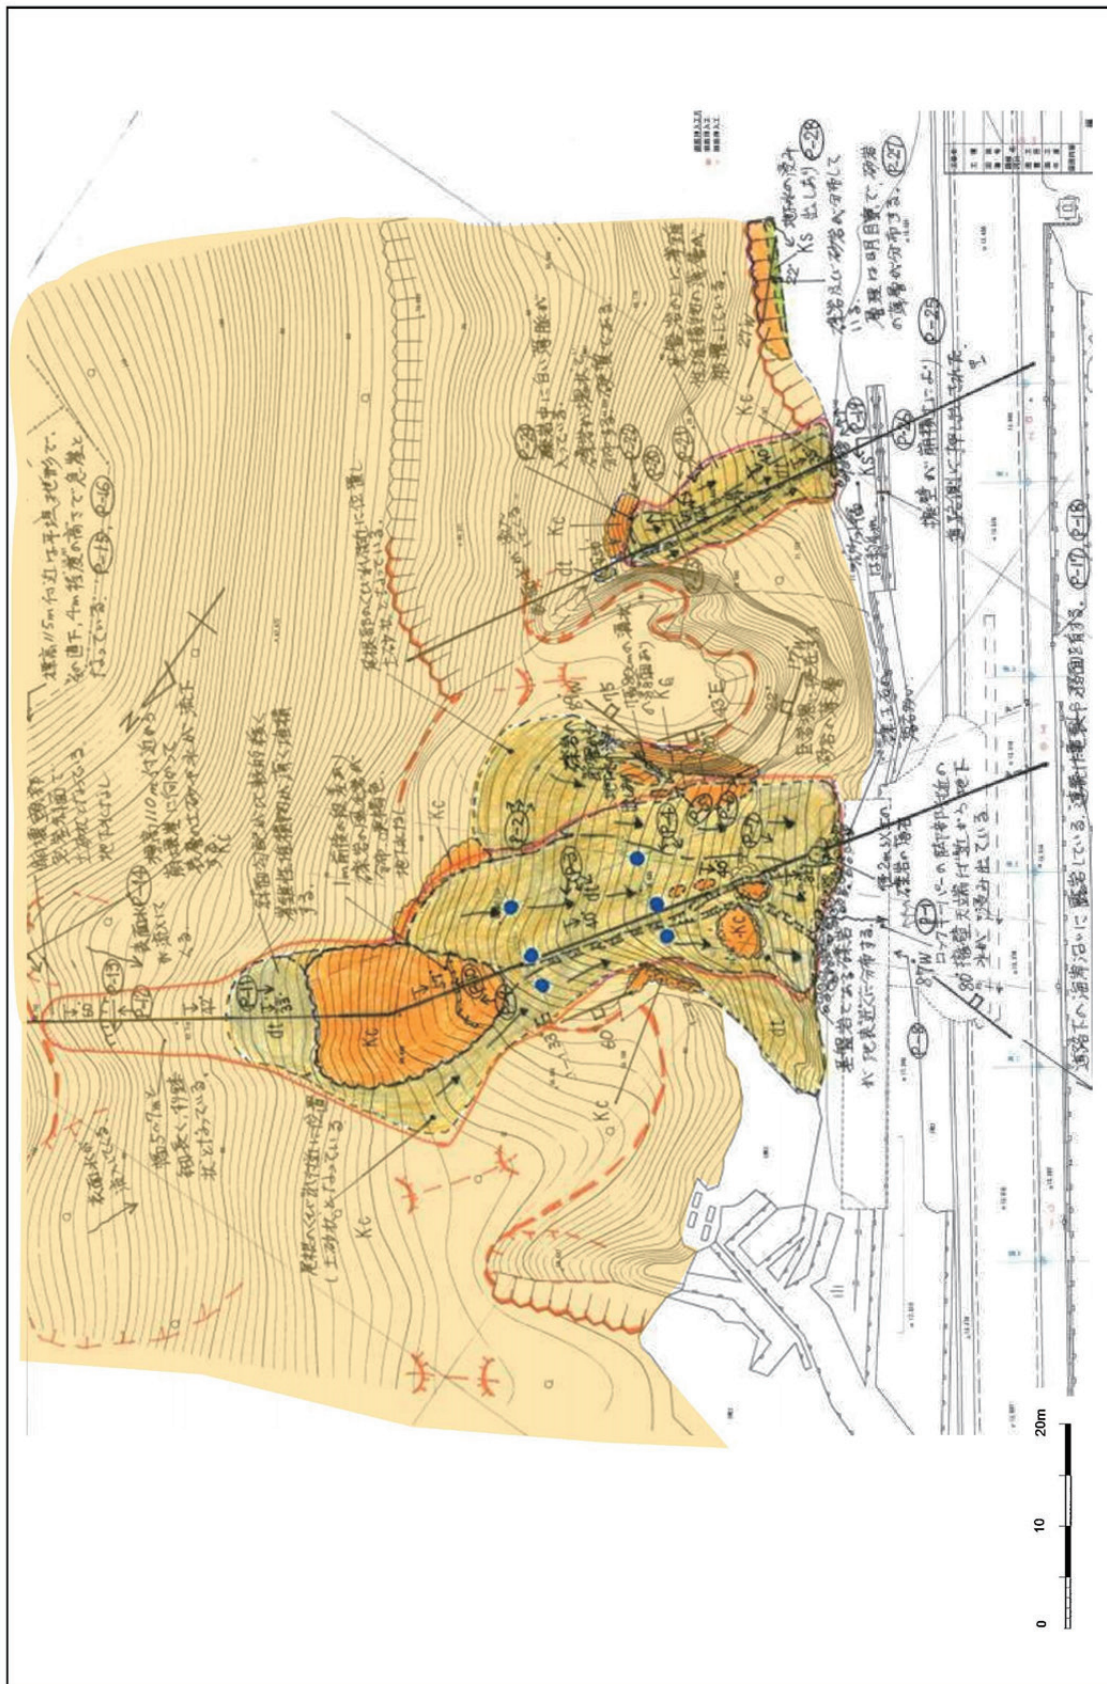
崩壊斜面踏査平面図 (スケッチ図)
